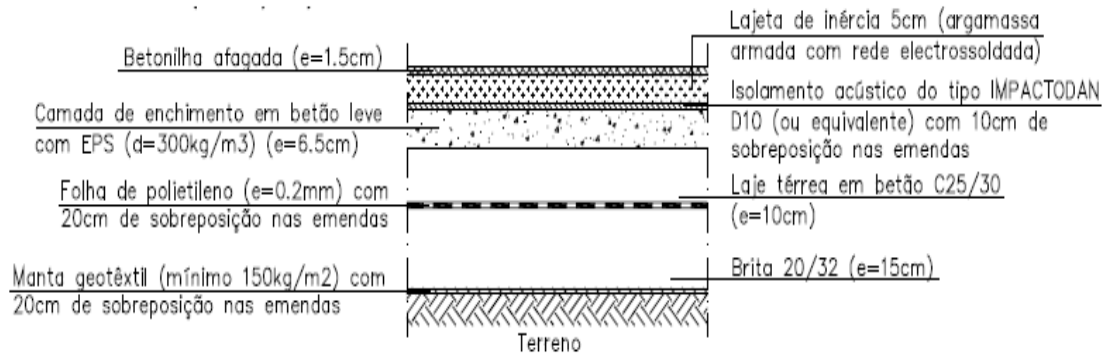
Pormenor da laje do piso térreo do comércio
